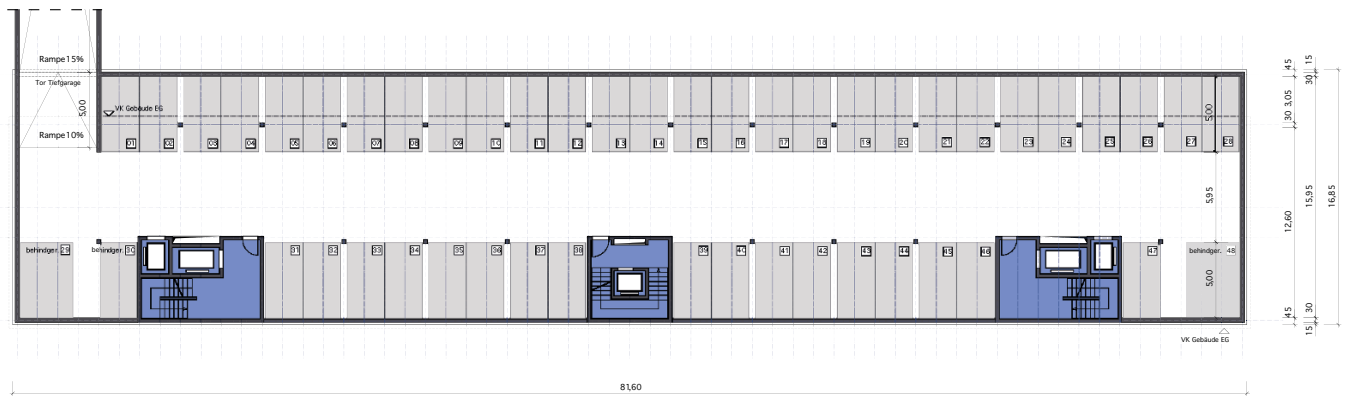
Grundrisse Referenzgebäude „hohe Variabilität“ für eine Büronutzung
